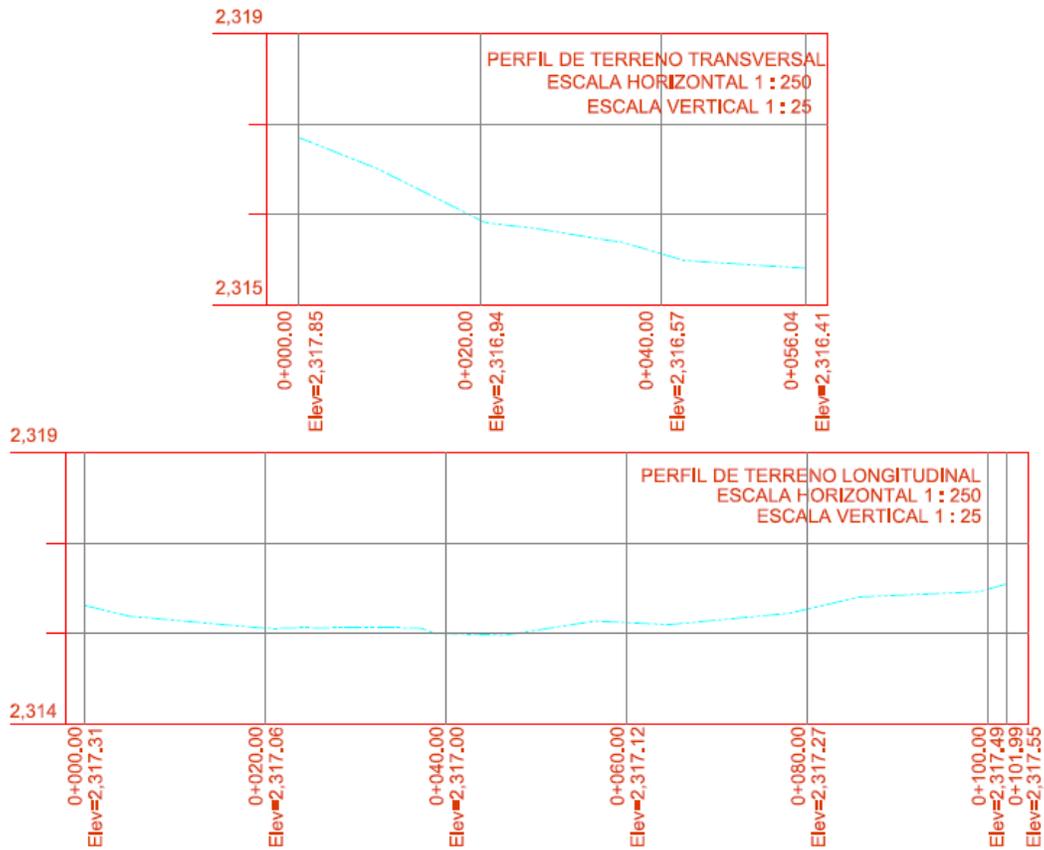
Detalle del perfil del plano topográfico.
